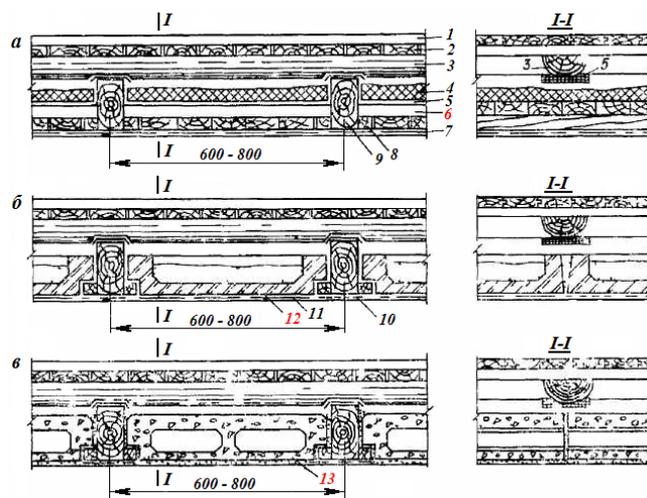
Междуетажные перекрытия по деревянным балкам: а – с деревянным щитовым накатом; б – с накатом из гипсовых плит; в – с накатом из шлакобетонных блоков
